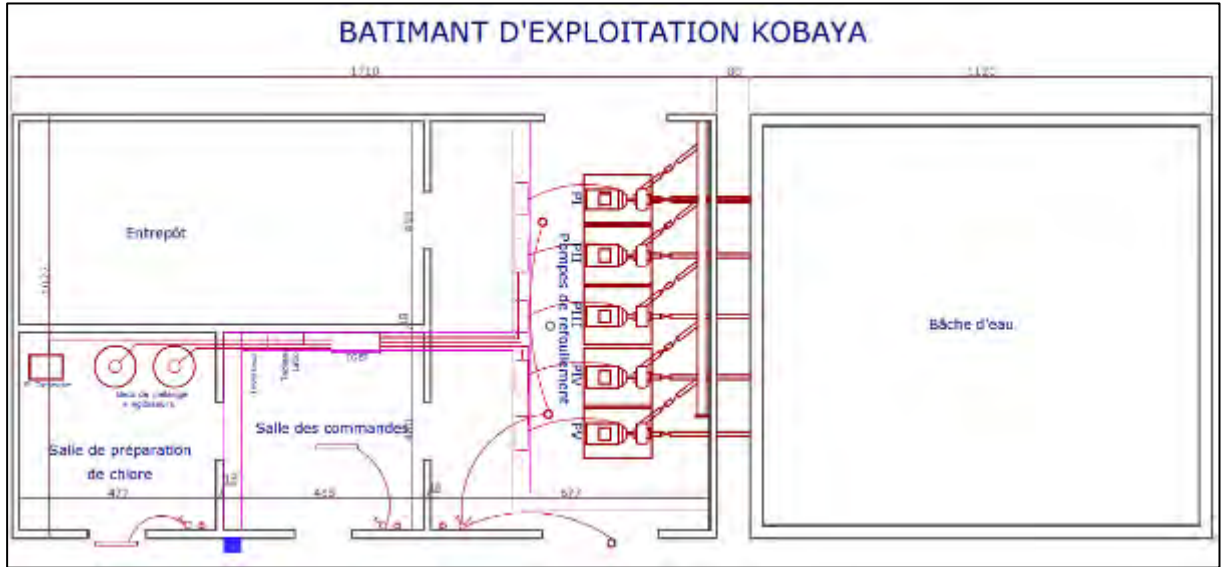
コバヤ送水ポンプおよび制御盤配置図
